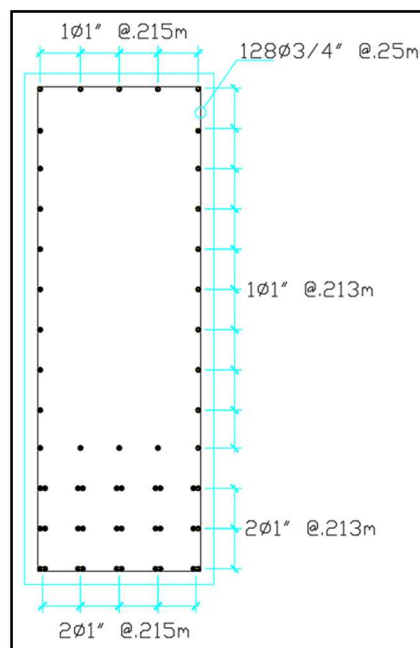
Distribución acero refuerzo viga 2.70 m x 1.00 m.
